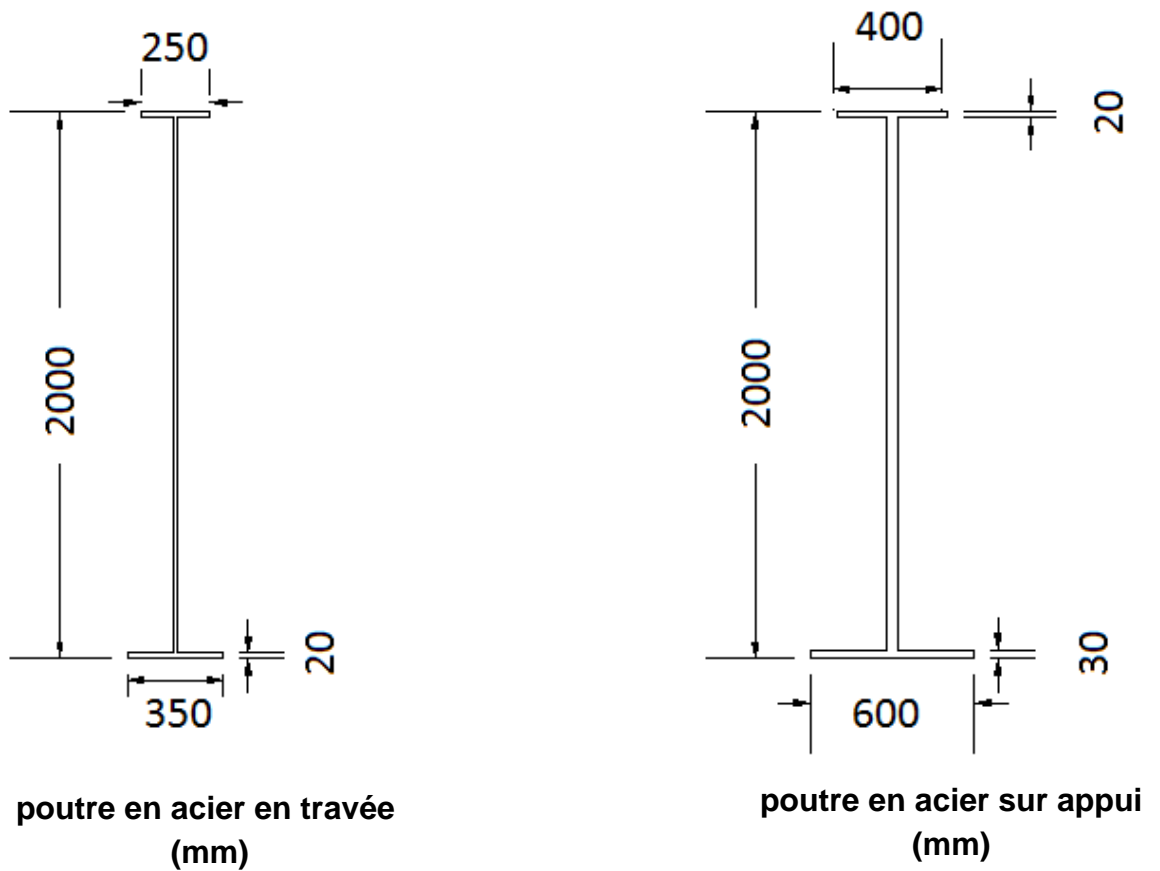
Sections transversal de la variante N°2 en (mm).
